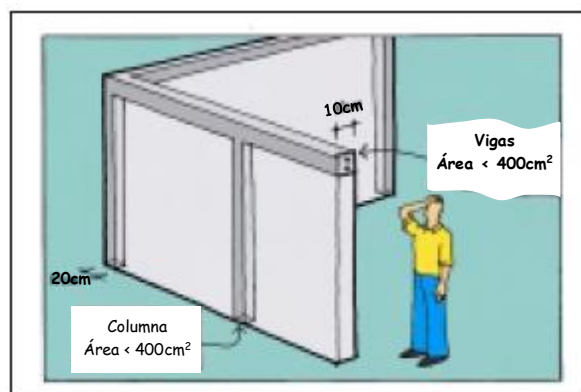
Detalles de columnas y vigas de confinamiento - Chavarría (2001)
